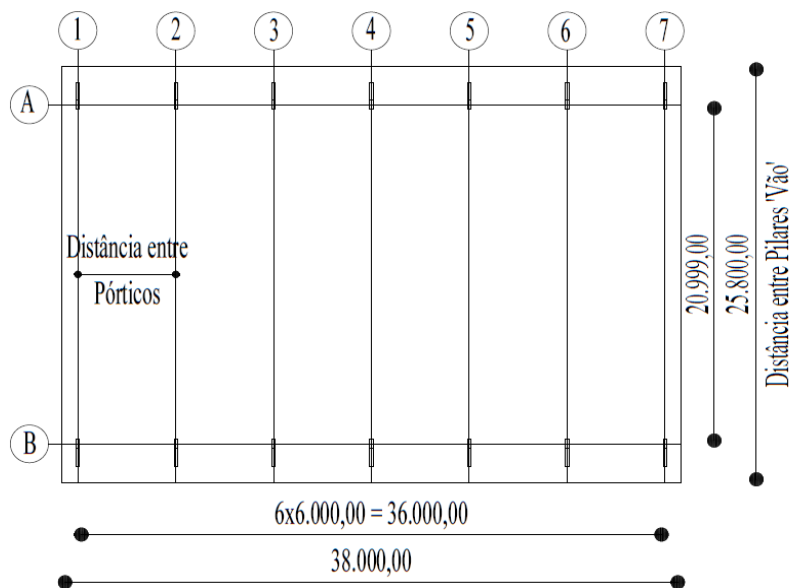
Planta de localização dos pórticos do ginásio do Gameleira, medidas em mm.
